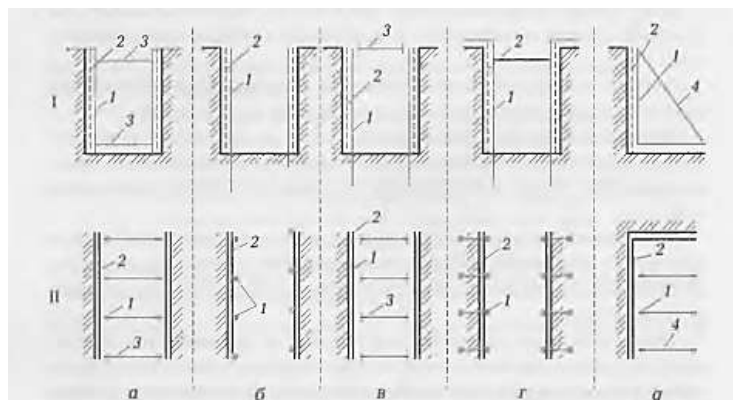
Схемы крепления вертикальных стенок выемок: I — поперечное сечение траншеи; II — план расположения креплений; а — стойчно-распорное крепление; б — консольное крепление; в — консольно-распорное крепление; г — консольно-анкерное крепление; д — подкосное крепление; 1 — стойка; 2 — щиты (доски); 3 — распорка; 4 — подкосы
